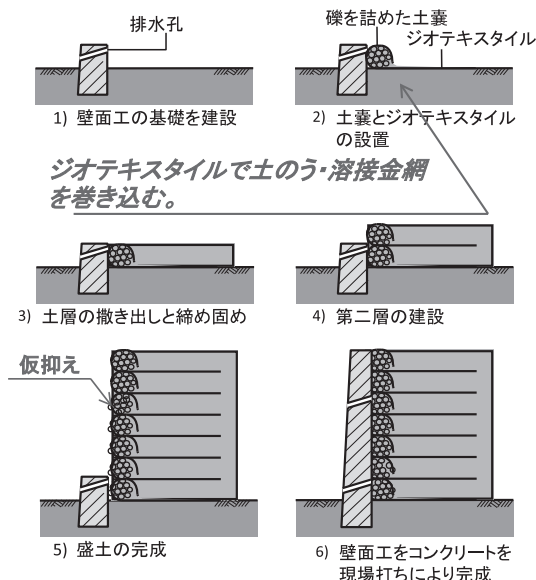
「GRS擁壁」の施工方法（段階式施工）<sup>1)</sup>
